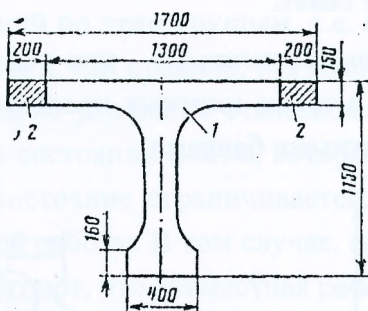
Поперечное сечение элемента предварительно напряженных пролетных строений: 1 – сборная балка; 2 – бетон омоноличивания.
